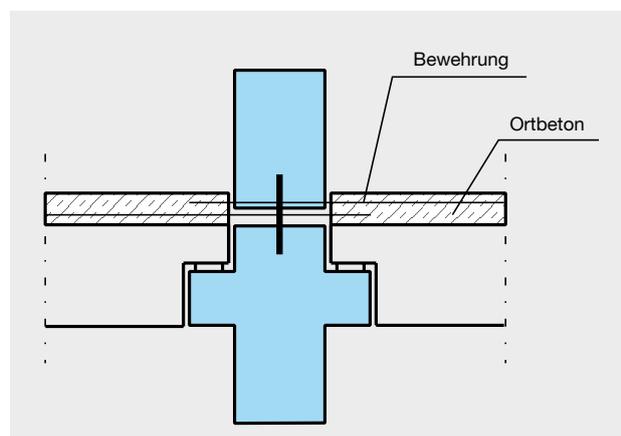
Einleitung von Horizontallasten in die Deckenscheibe
